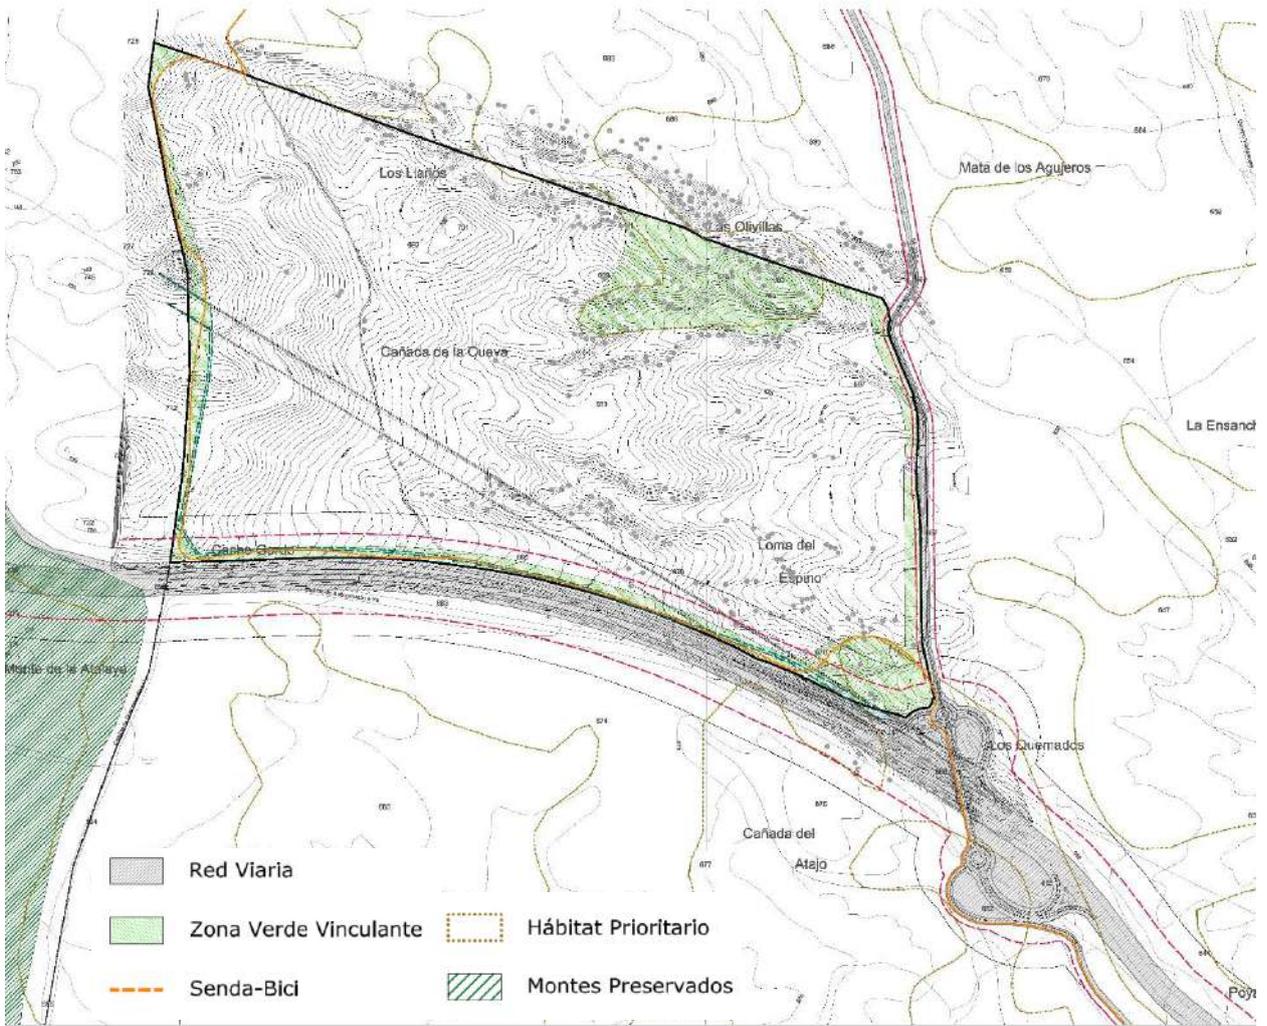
Plano de Redes Públicas y elementos exteriores (Fuente: C+LL).
